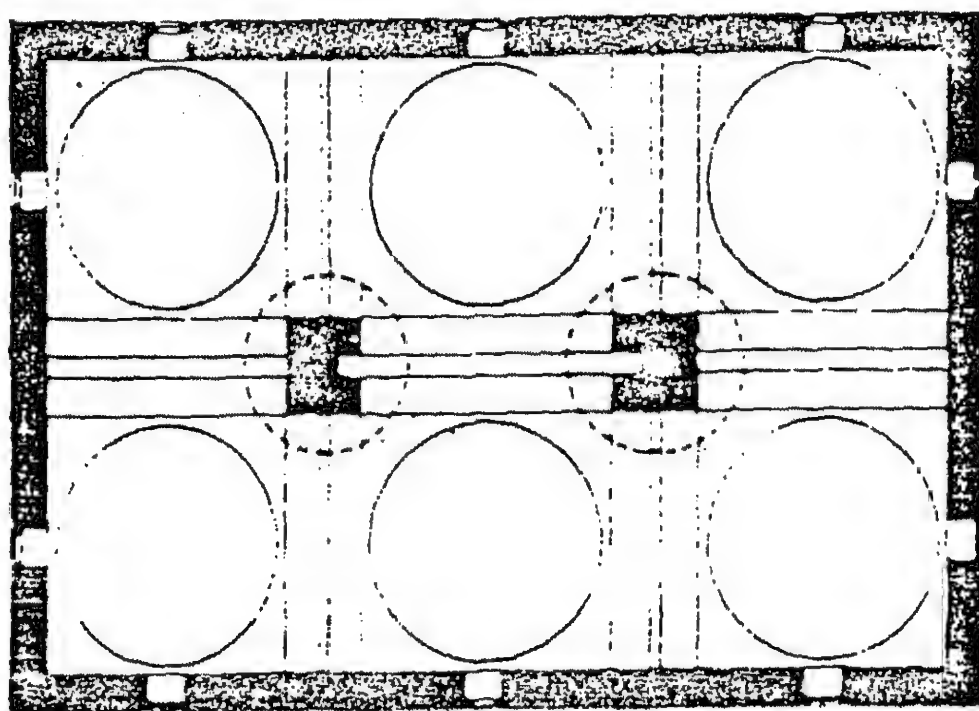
مسقط أفقي لجلطة بادستان بإستانبول (عن: Cezar).
